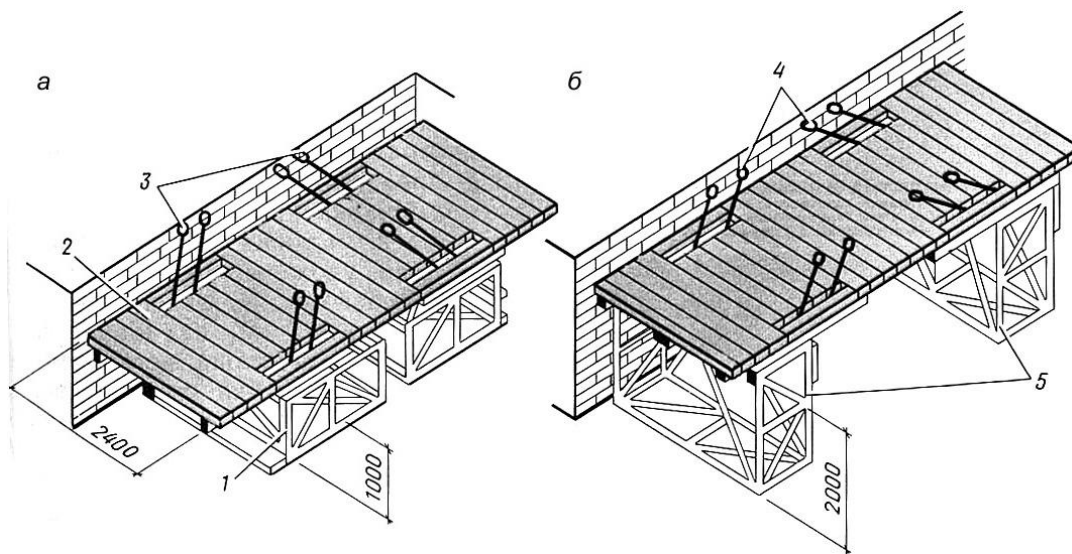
Установка універсальних риштувань: а) для кладки 2-го ярусу; б) для монтажу 3-го ярусу; 1 - прямокутні опори в нижньому положенні; 2 - робочий настил; 3 і 4 - стропи для перекладу опор у вертикальне і горизонтальне положення; 5 - прямокутні опори у вертикальному положенні
